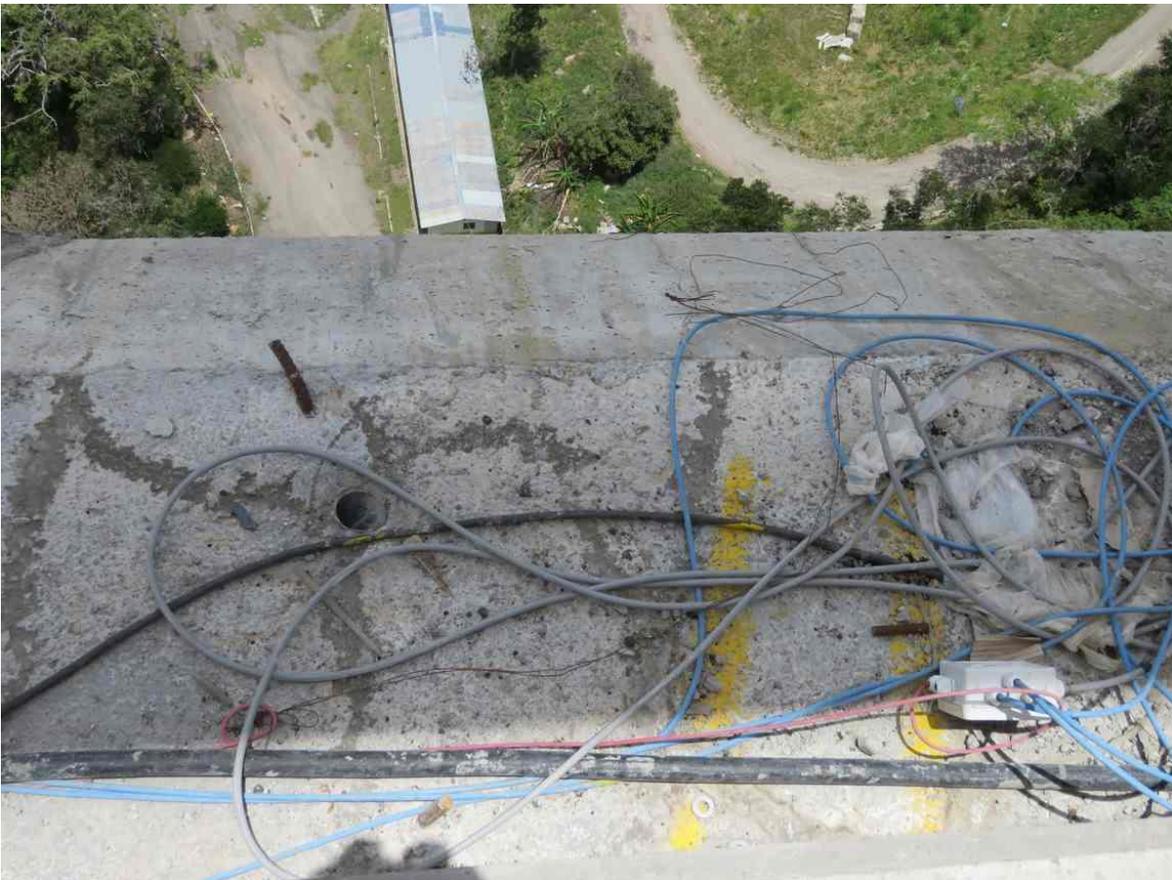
Vista lateral lado Málaga aguas arriba.
